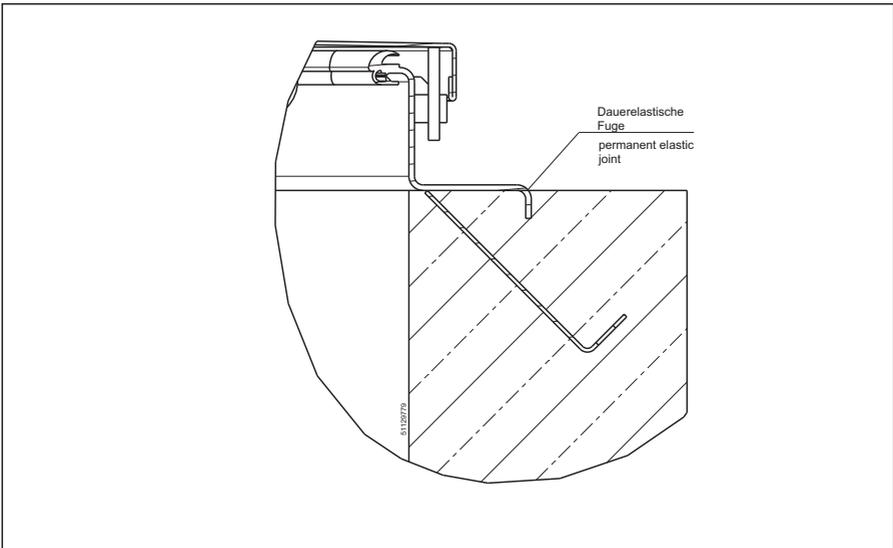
Rahmen zum Einbetonieren (SD1, SD2)
